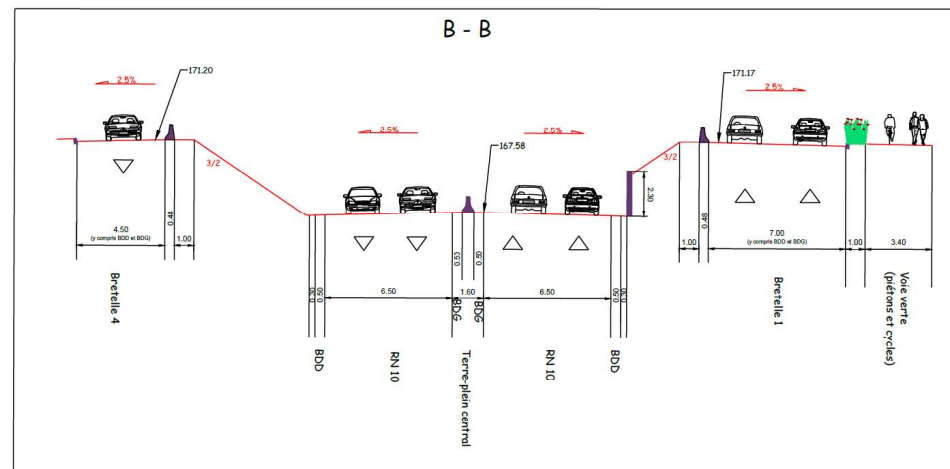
Profil en travers type du barreau de la solution retenue (sous-variante 3)
